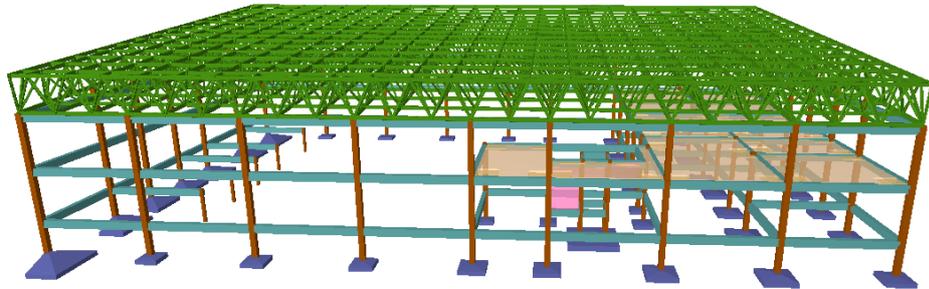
Estructura de hormigón armado y metálica bloque SUM. Fuente: propia.
